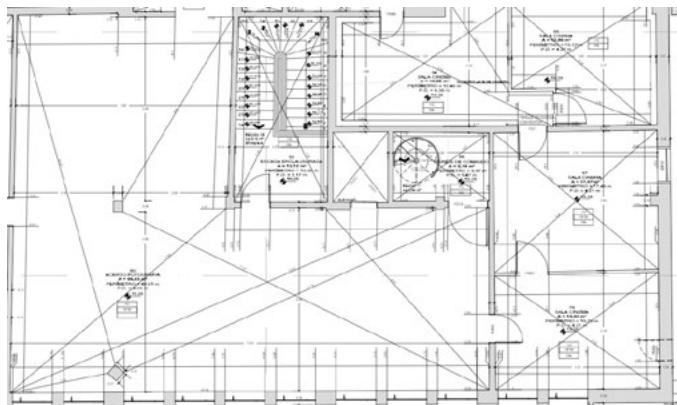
[Recorte] URBANA ENGENHARIA. Planta Baixa Quarto Pavimento. Levantamento Cadastral 17/37. Projeto de Restauração e Adequação MuseCom, 2017 (URBANA/IPHAE/IPHAN).
